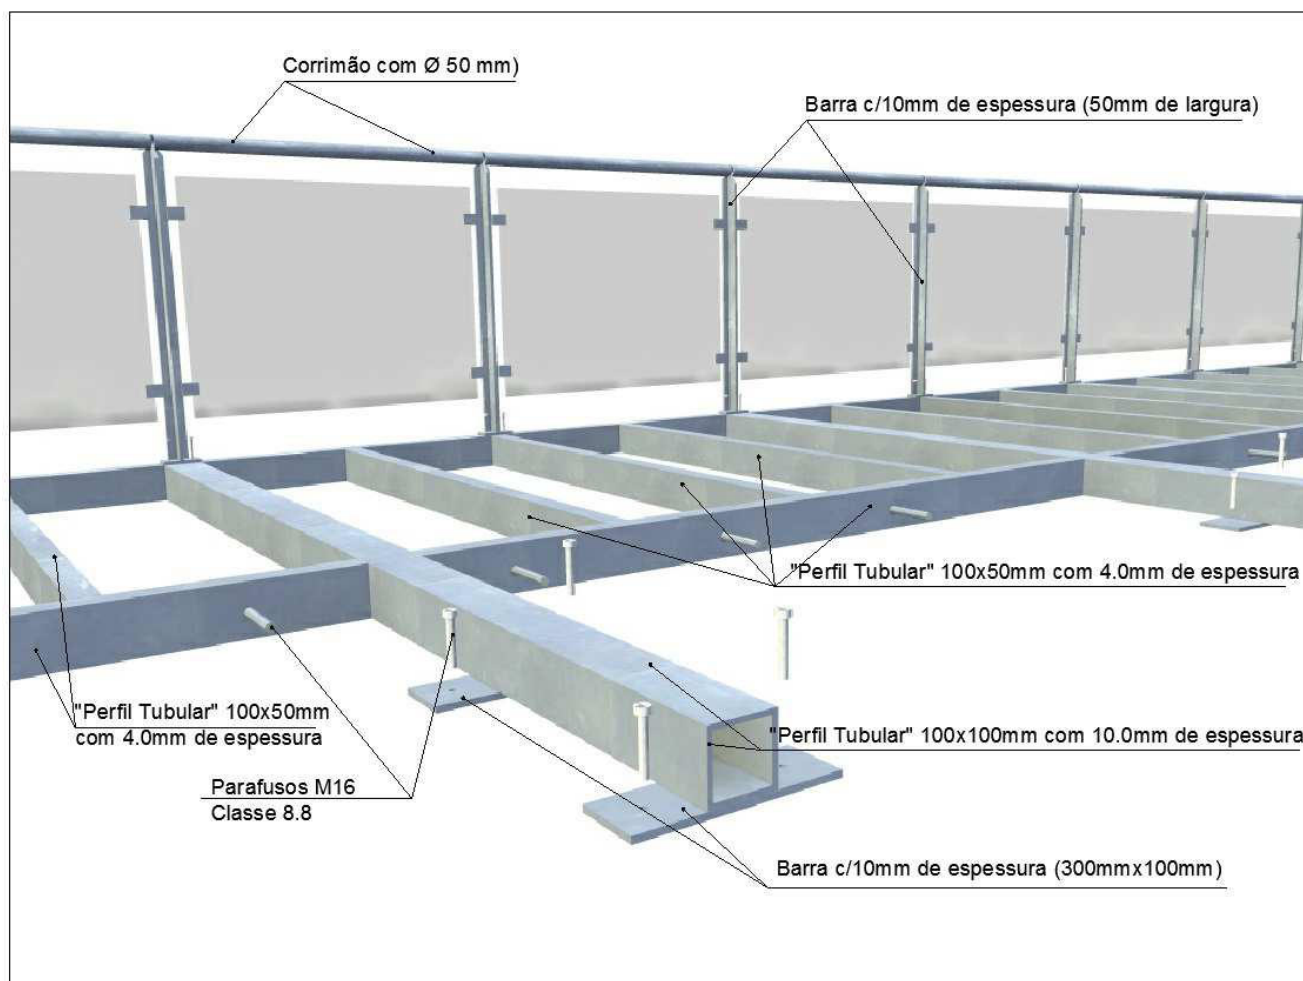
Pormenor em 3D da estrutura do passadiço / varanda – “Ninho de empresas”
